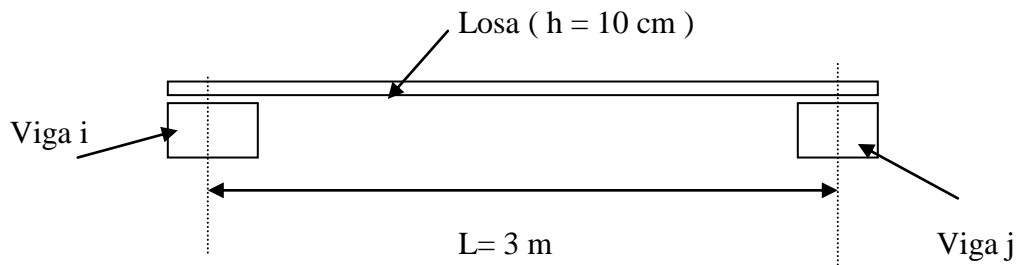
Sistema estructural de losas y vigas cargueras en el edificio
